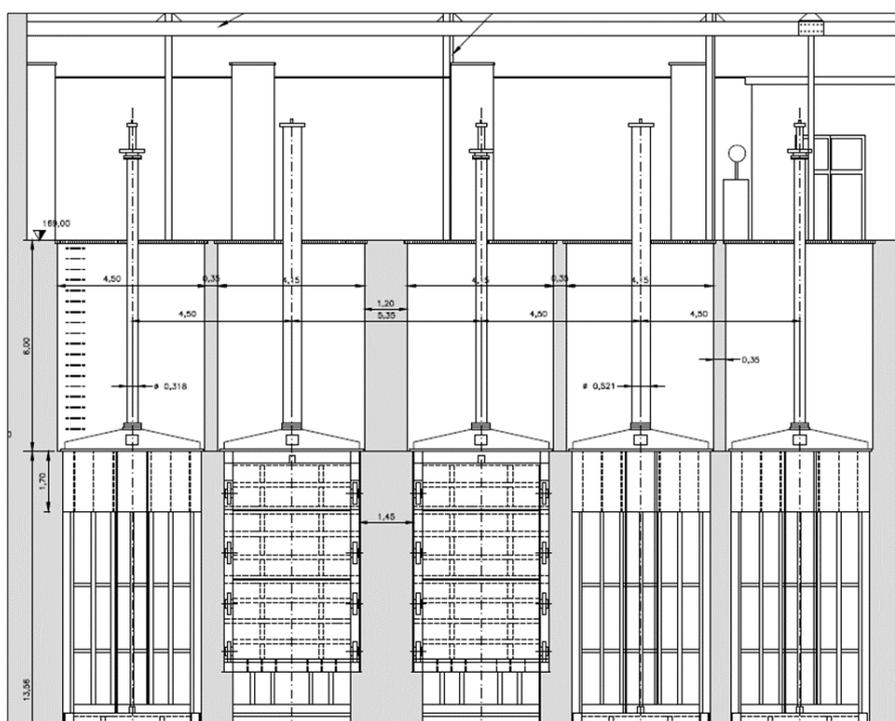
Tavola di consistenza del progetto Cesi - stralcio sezione longitudinale accesso alle paratoie di presa della Centrale idroelettrica
